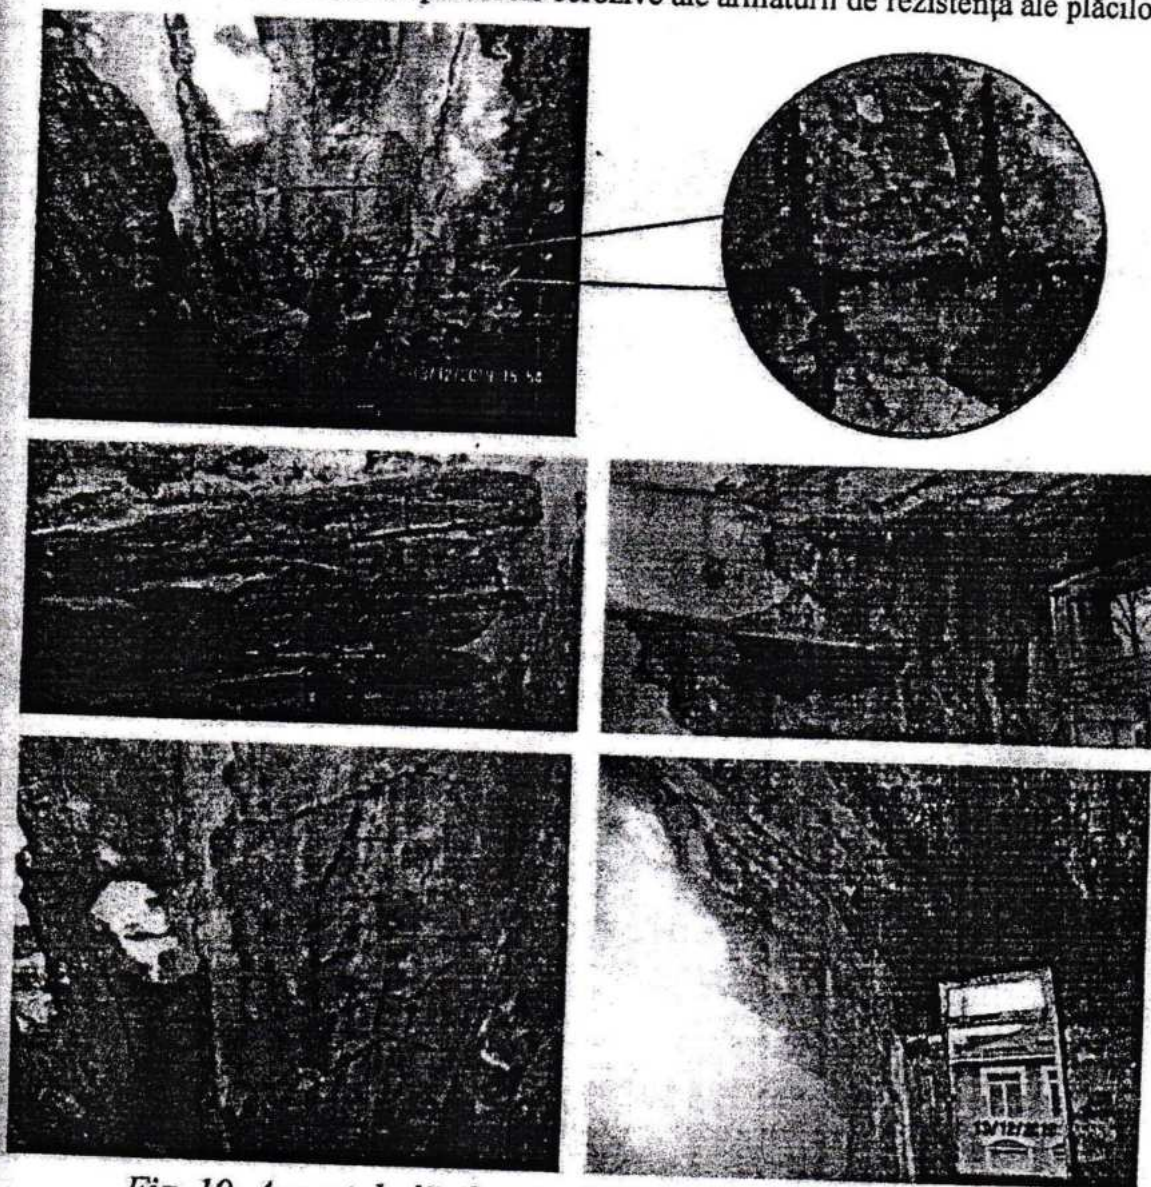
Aspectul plăcilor de planșeu cu urme de coroziune a armăturii de rezistență în interiorul betonului.
